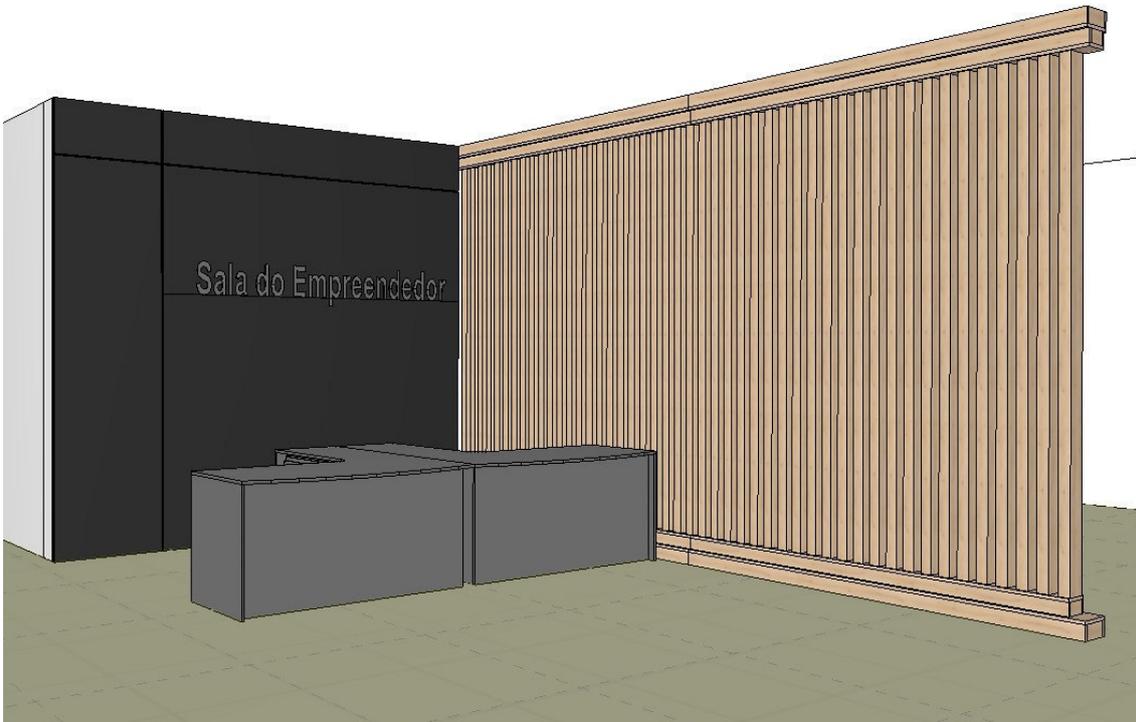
Divisória Ripada Hall de Entrada (Vista posterior) e painel da Sala do Empreendedor.
